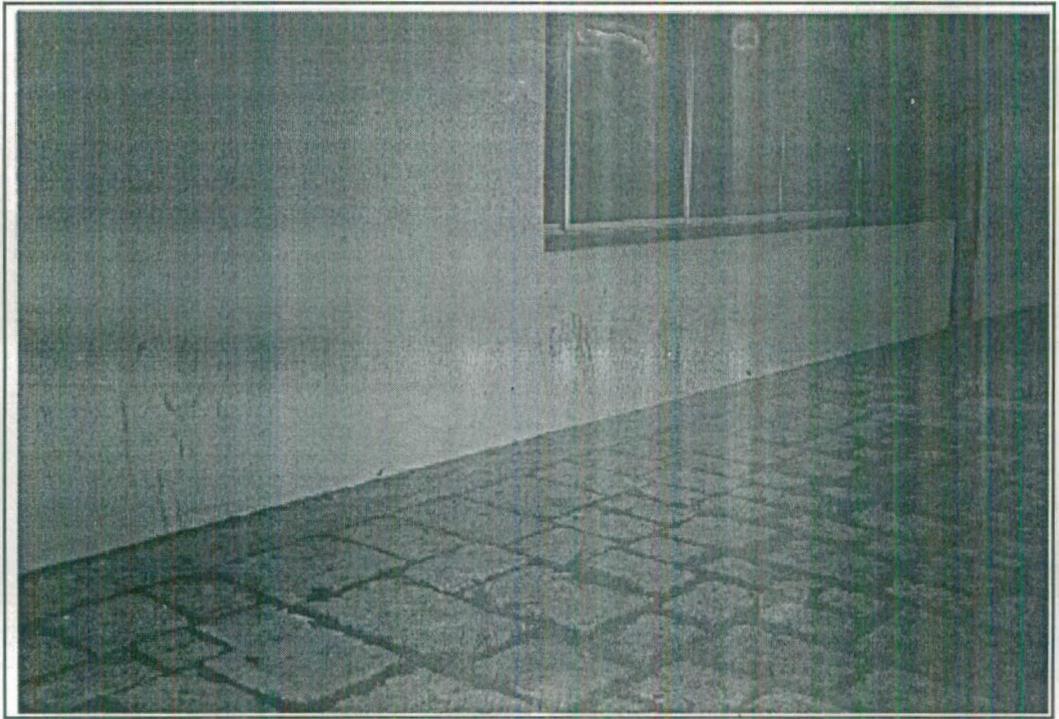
Estado de recubrimiento de hormigón visto en fachada lateral de sector principal.
